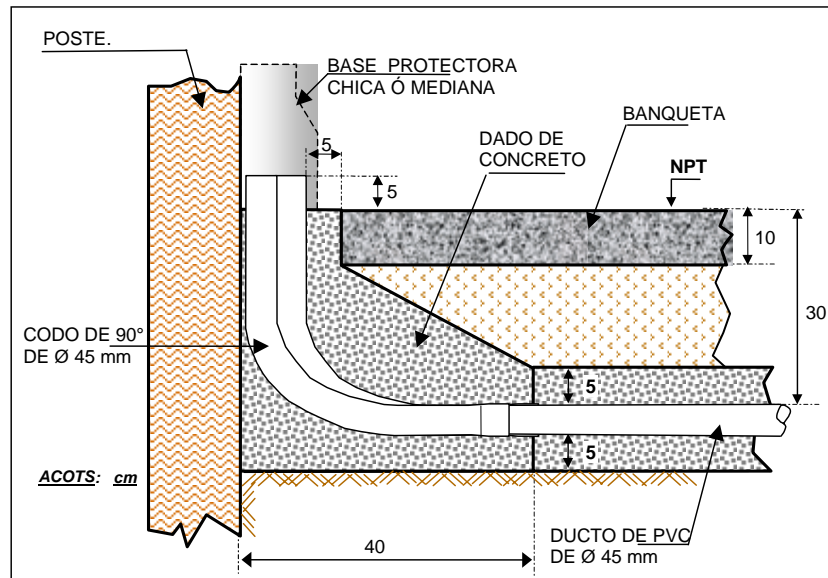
Colocación de ductos de PVC para subir cable a poste
